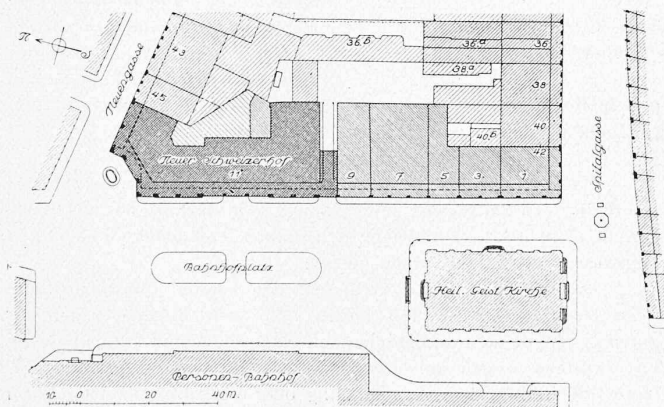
Lageplan des neuen Hotel Schweizerhof. — 1:2000.
